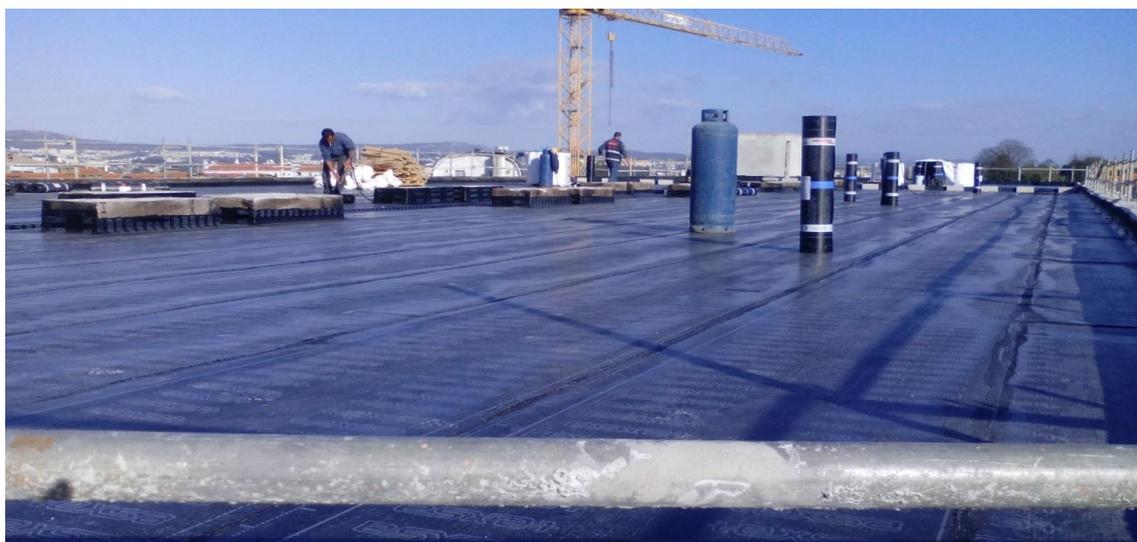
Aplicação de tela de impermeabilização (foto do autor)
